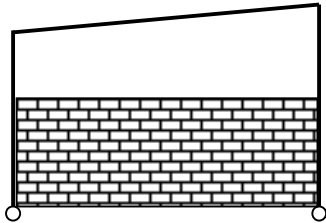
Effet d'un remplissage partiel ultérieur à la construction sur la répartition des efforts nécessaires à la stabilisation latérale d'une structure pour un exemple de poteaux encastrés à la base et articulés en tête
